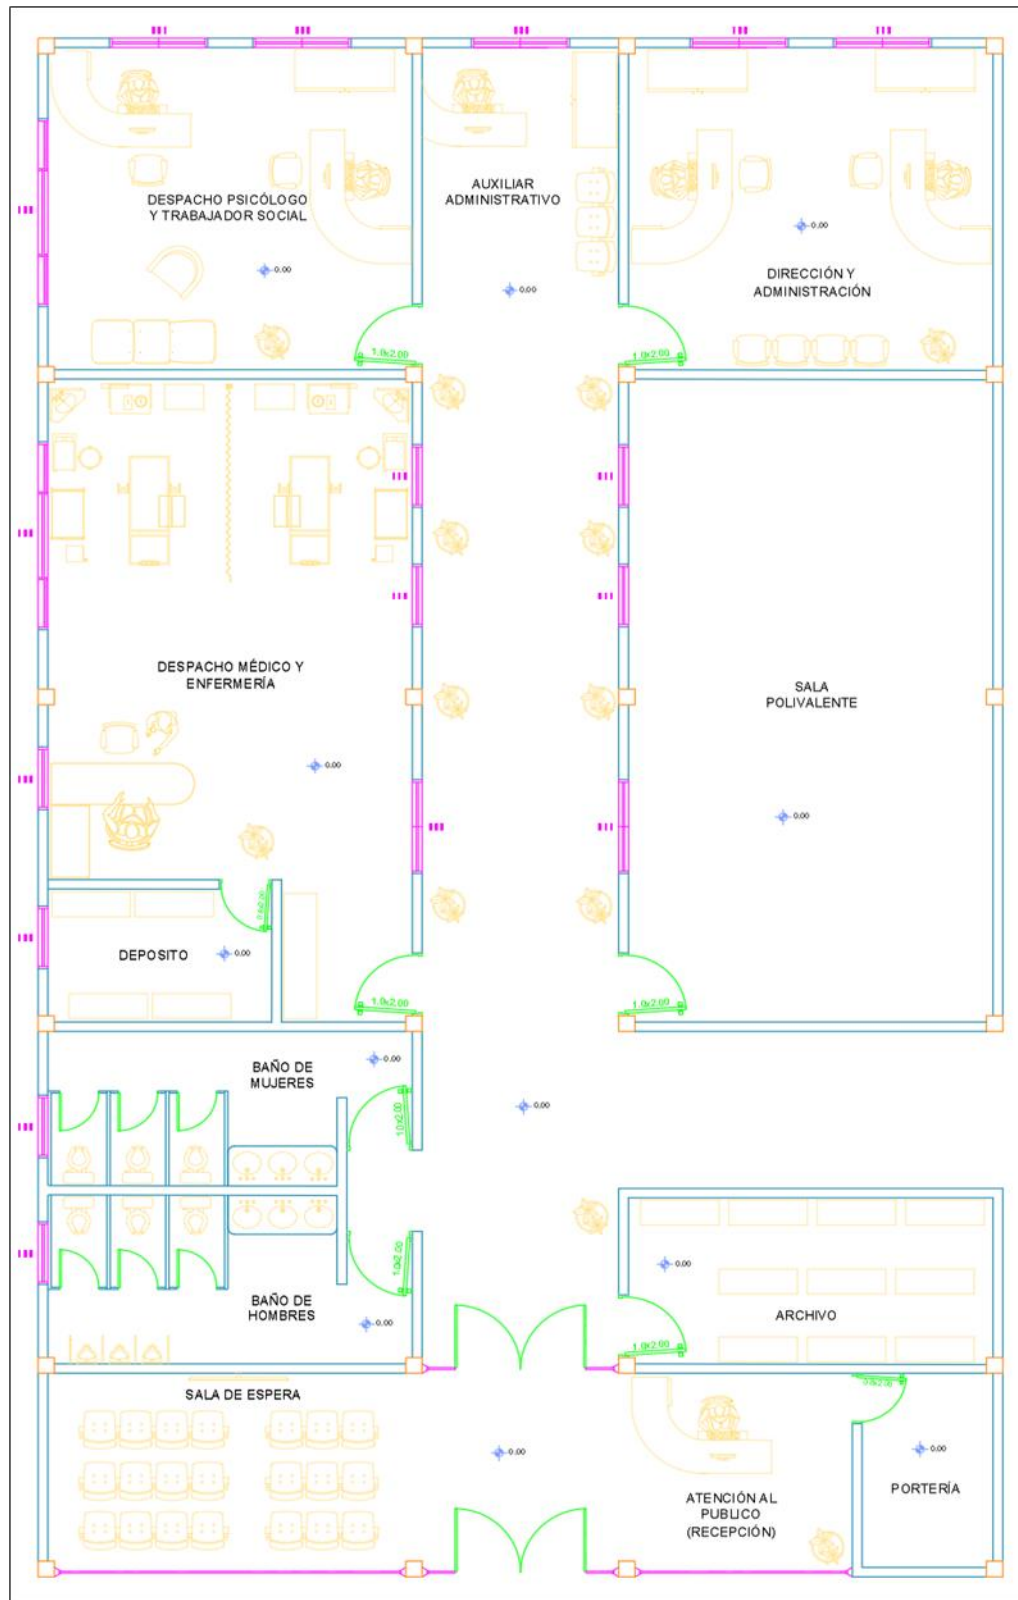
Diseño arquitectónico de la estructura 1 del Centro Vida. Fuente: Autores del proyecto.
